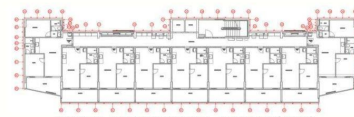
PLANTA DE BALANCINS - PAVTO TIPO 1º AO 11"
